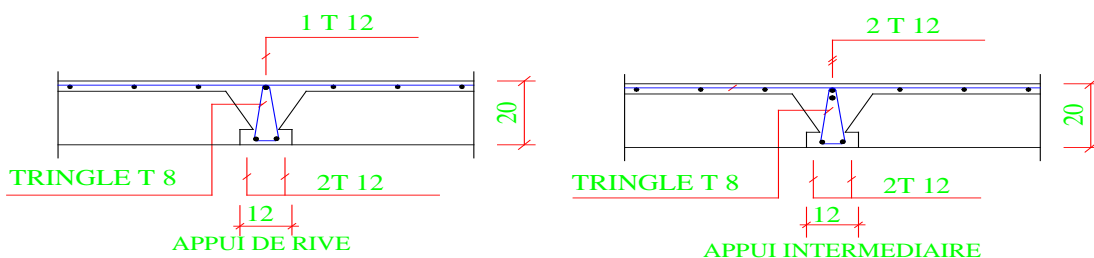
ferrailage coupe en travée./Figure (IV.10) : ferrailage coupe en appuis.
